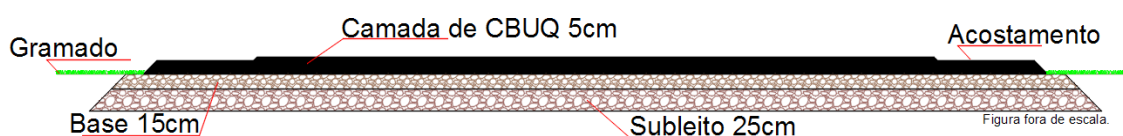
Desenho da seção típica da estrutura do pavimento investigado da BR-153.
